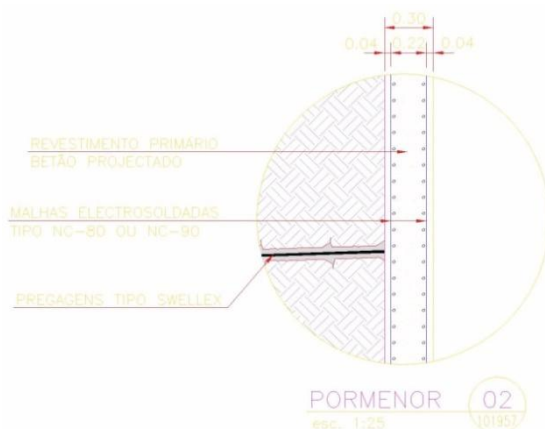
Pormenor do revestimento primário (adaptado TF, 2011).
